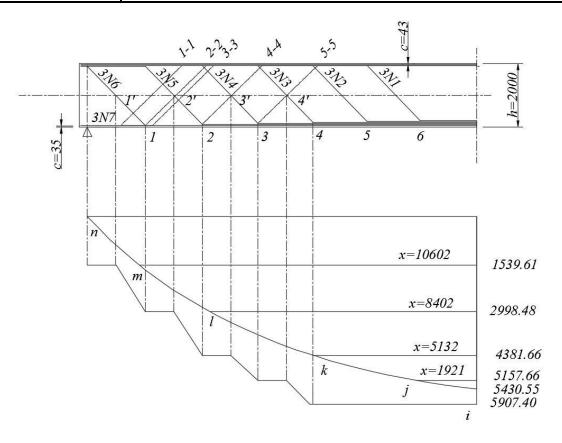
梁的弯矩包络图与弯矩抵抗图(尺寸单位:mm;弯矩单位  $kN \cdot m$ ) 现在以图 7 所示弯起钢筋弯起点初步位置来逐个检查是否满足《公预规》要求。第一排弯起钢筋(3N6):
